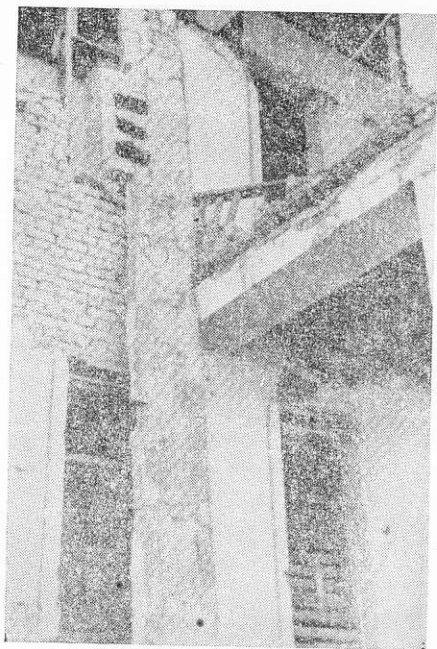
Обрушение антисейсмического пояса, слабо связанного с кирпичной кладкой и с балками перекрытия (пояс висит вертикально)
